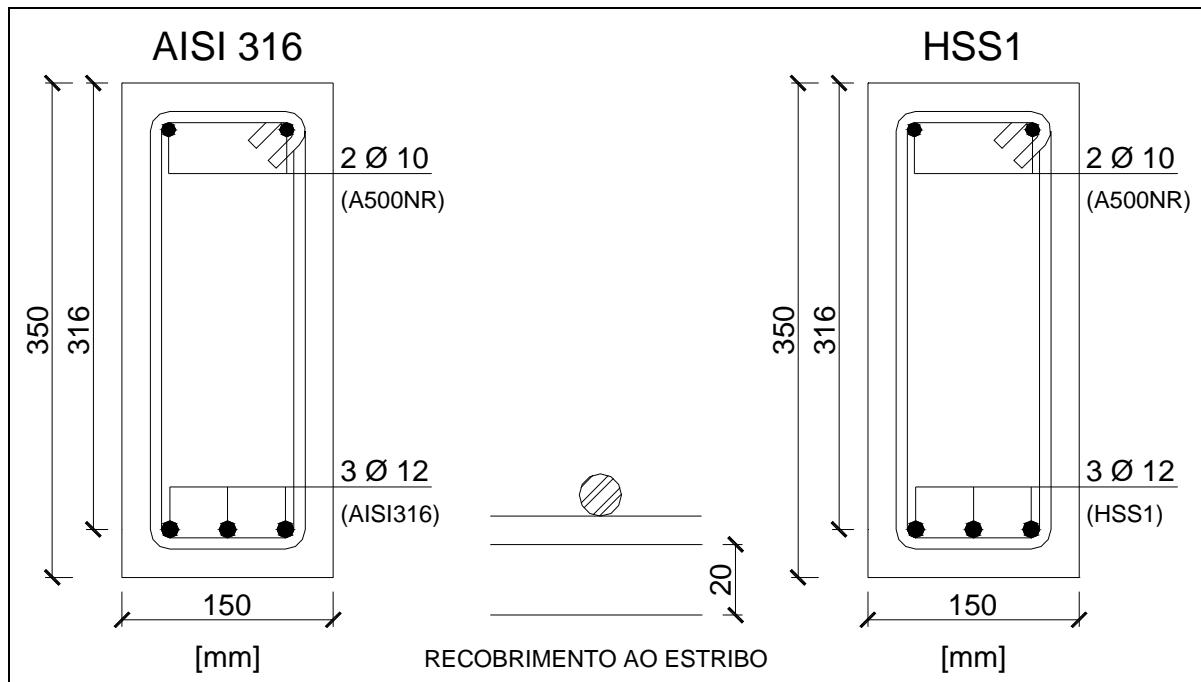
Detalhe da secção transversal das vigas de aço inoxidável da 1.ª série.
